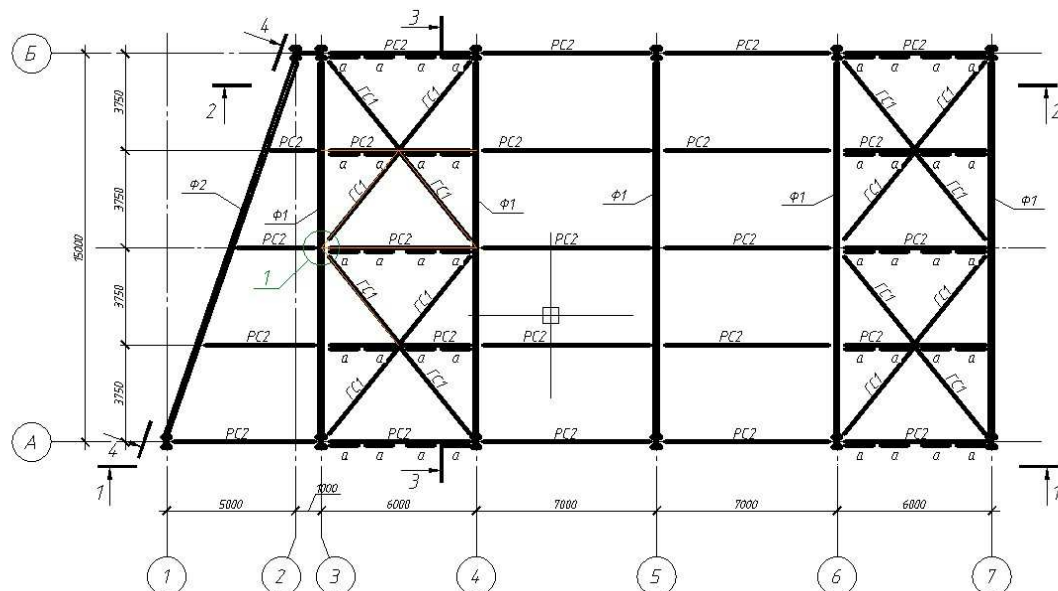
Схема расположения связей по нижним поясам стропильных ферм
